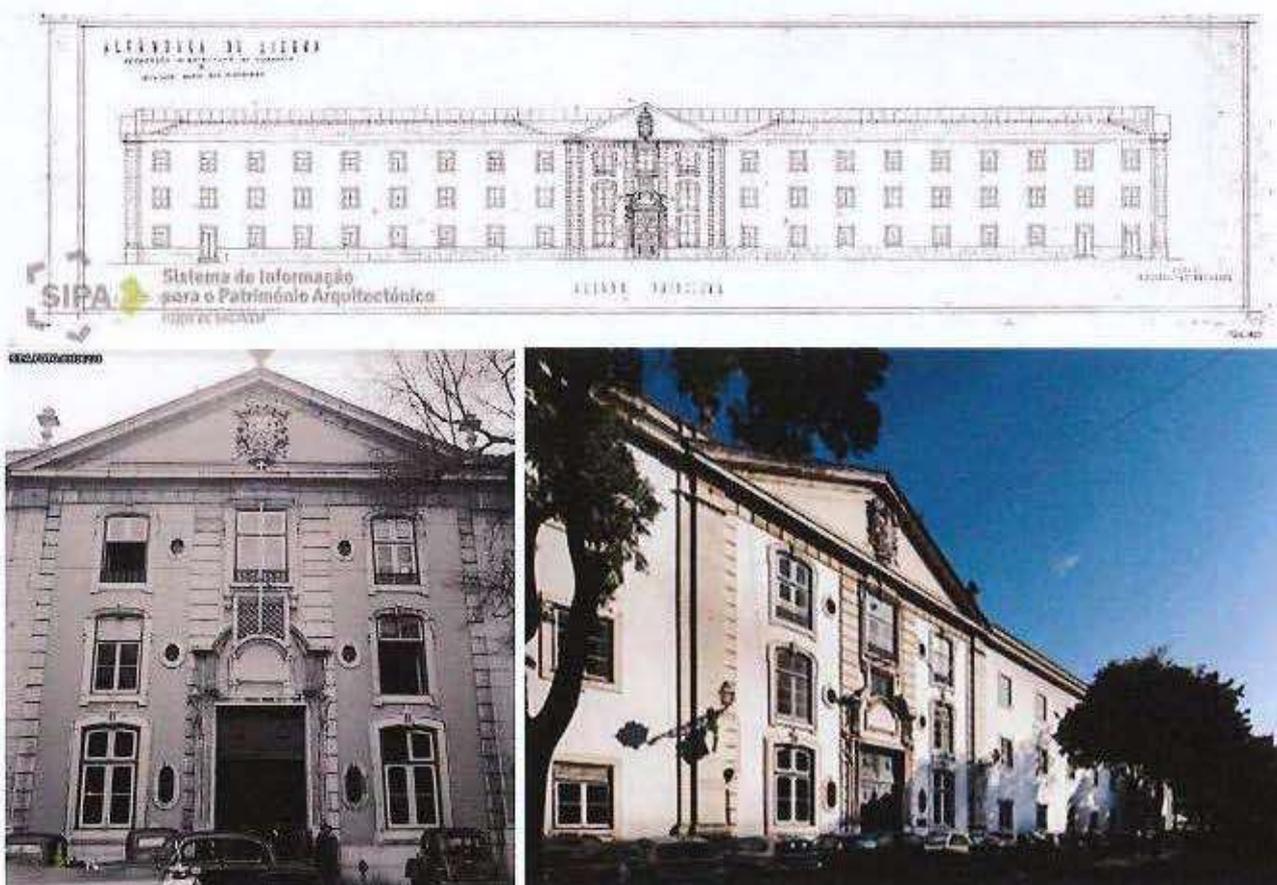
Fachada norte do Terreiro do Trigo (alçado e foto de arquivo em <http://www.monumentos.gov.pt>, e fachada na atualidade).
